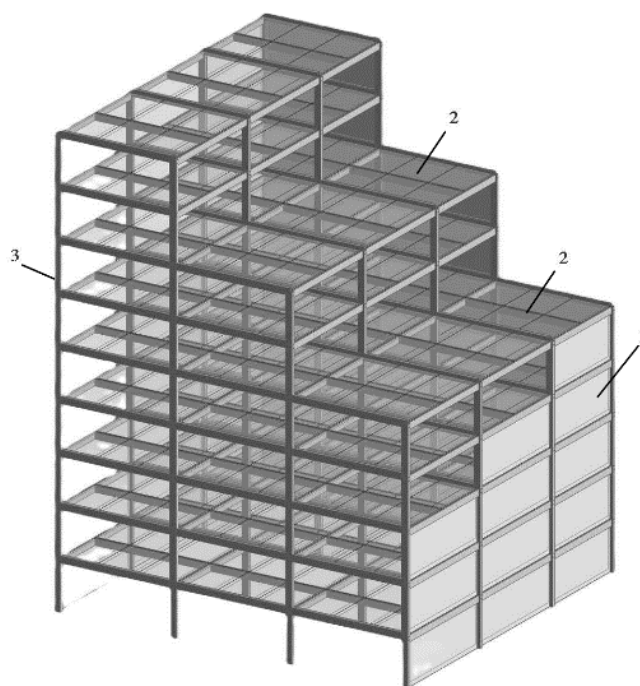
Пример комбинированного каркаса из конструкций железобетонных, со стеновыми дисками и (или) перекрытиями из деревянных панелей: 1 – стеновые деревянные панели; 2 – деревянные панели перекрытия; 3 – железобетонный каркас с жесткими узлами сопряжения стержневых элементов.
